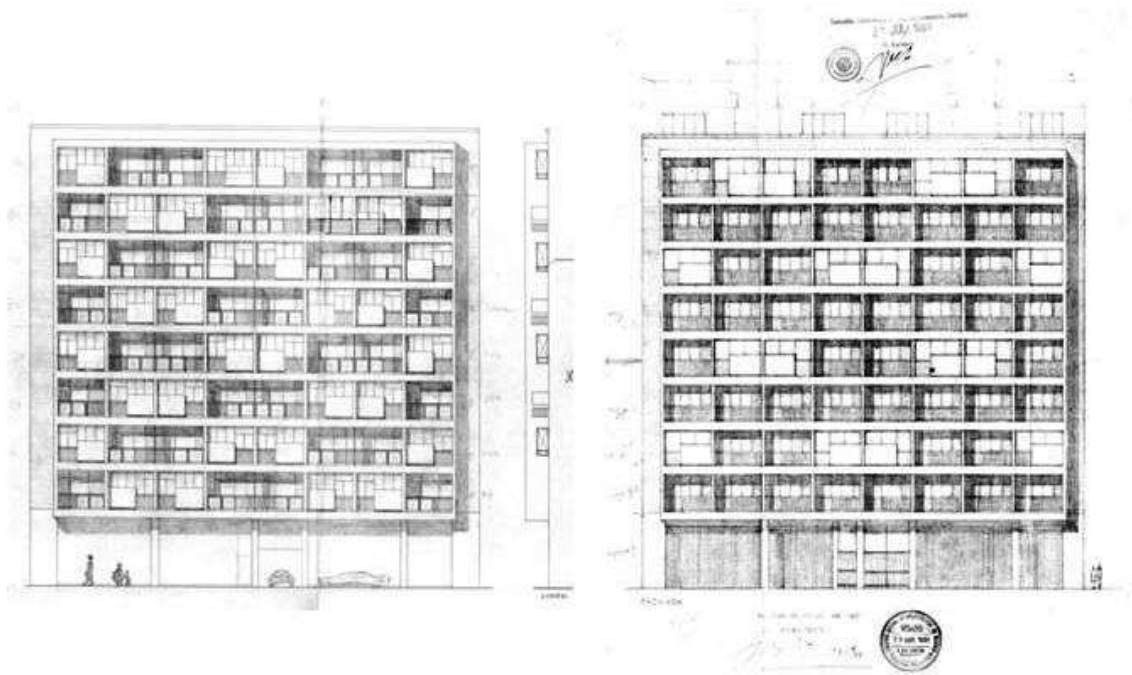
a) Posible plano de obra b) Plano firmado, visado y presentado para solicitud de licencia.
